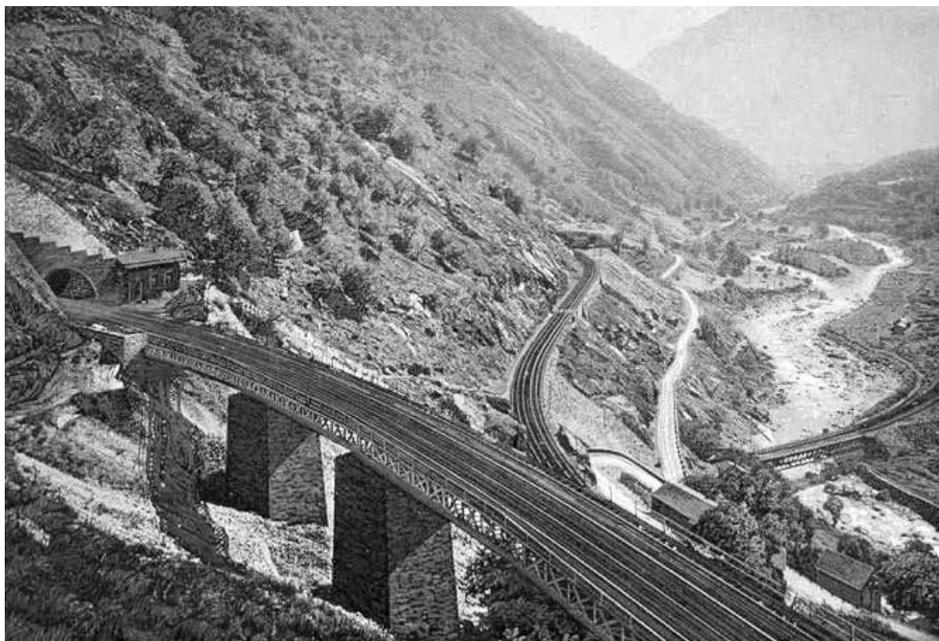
Viadotto e galleria di Pianotondo (cartolina, s.d., collezione privata)
